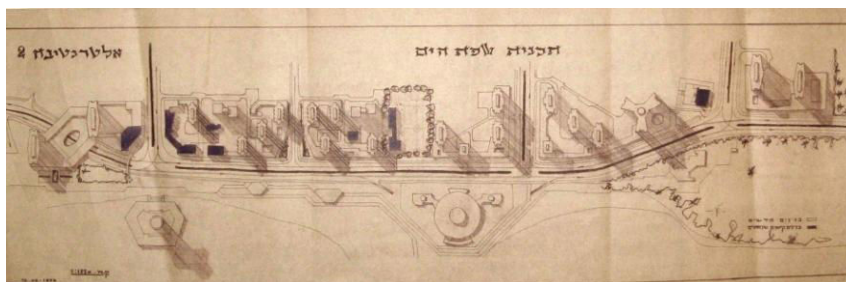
La ville en mégastructures: des tours au long de la plage, plan
